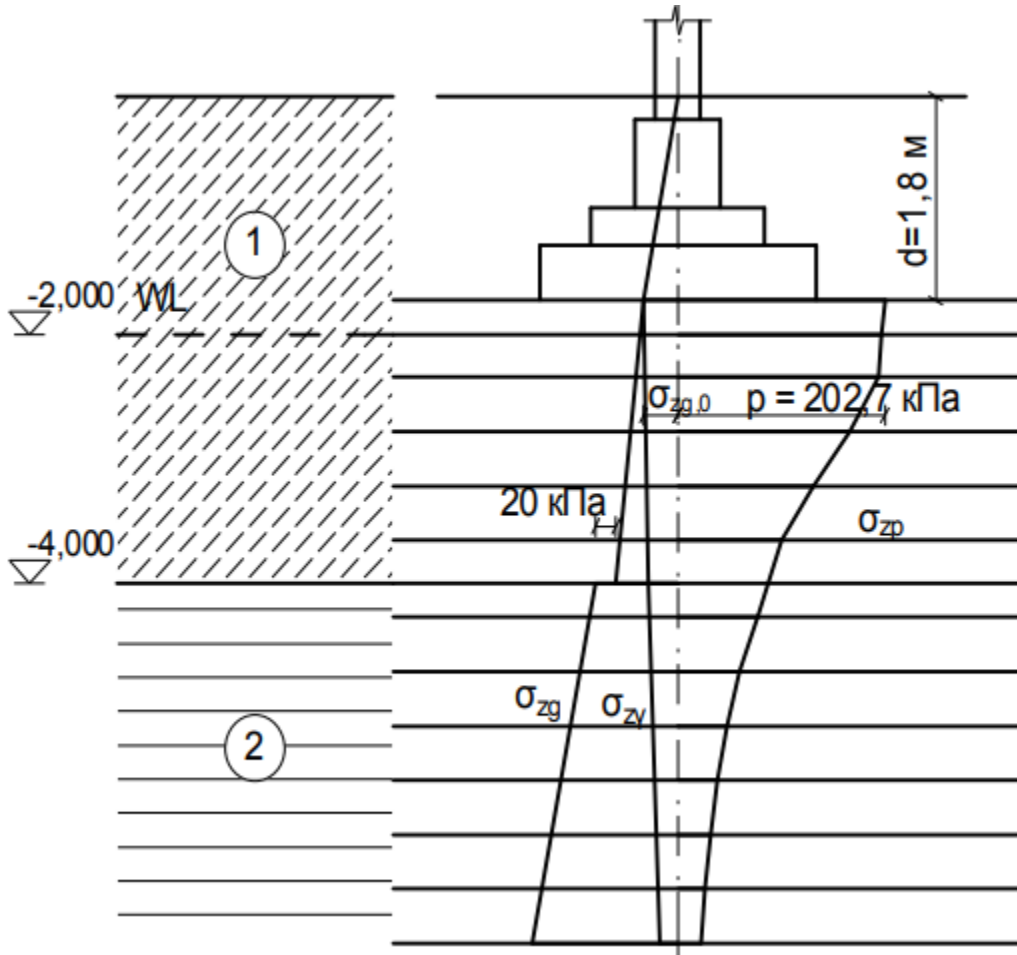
Розрахунок осідання фундаменту методом пошарового підсумовування
